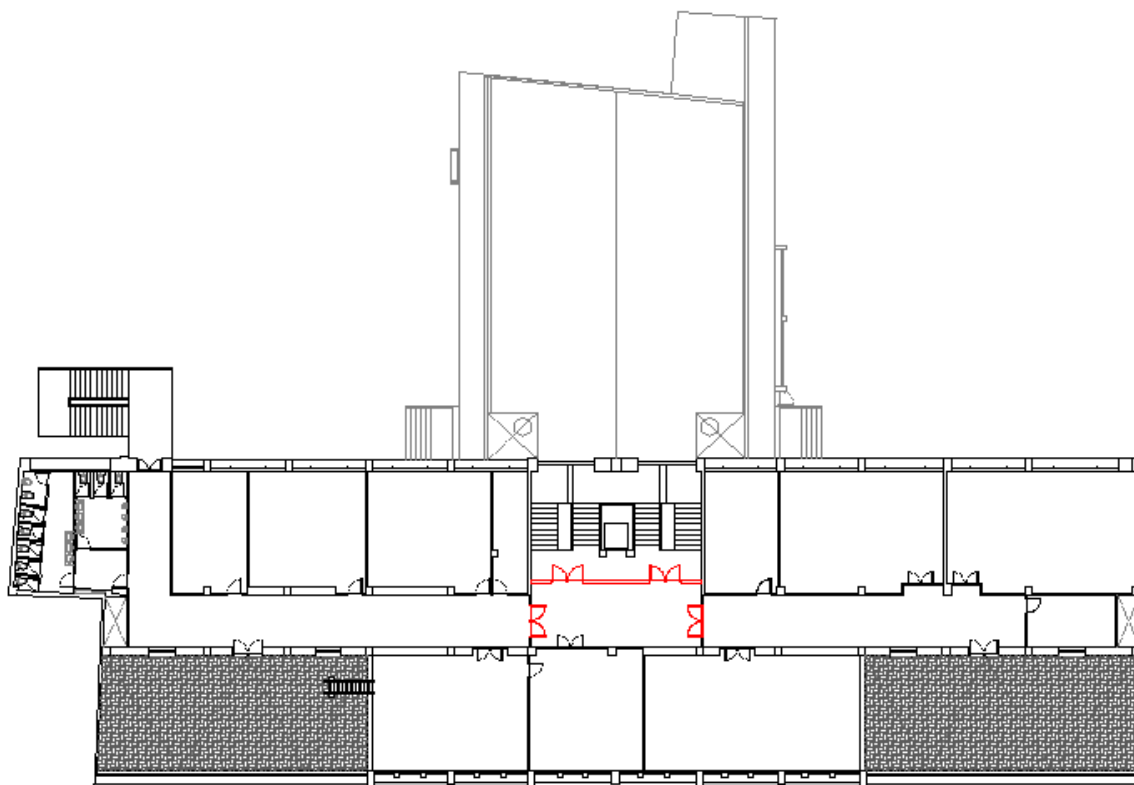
Propuestas de actuación en puertas planta cuarta. Fuente: Elaboración propia.
